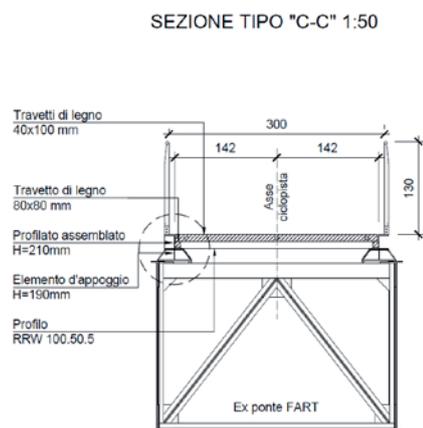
Umbau der Eisenbahnbrücke zwischen Visletto und Cevio (neue Passerelle mit 3.0 m Breite)
